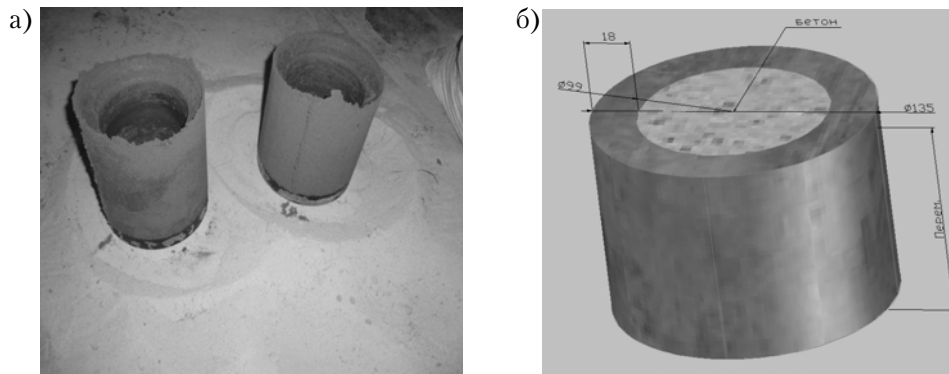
Изготовленные образцы: а – фрагмент несъемной бетонной опалубки; б – трубобетон.
